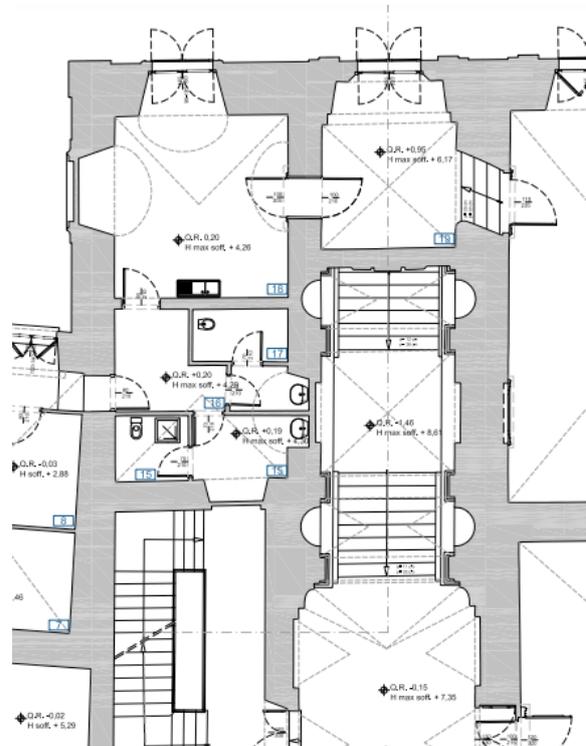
Pianta piano primo della scala “del Michela”, Castello di Agliè, rilievo stato di fatto (da Atelier Architectural restoration project 2020-2021, 01UWQPV, Proff. E. Fabrizio, S. Fantucci, E. Morezzi, P. Palmero, G. Piccablotto).
